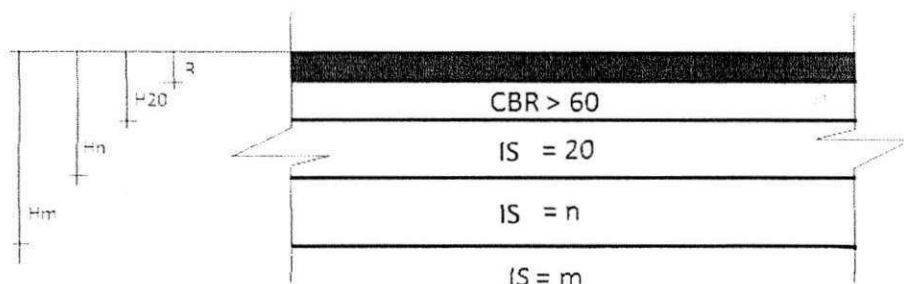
Camadas do Pavimento (SENÇO, 1997).
